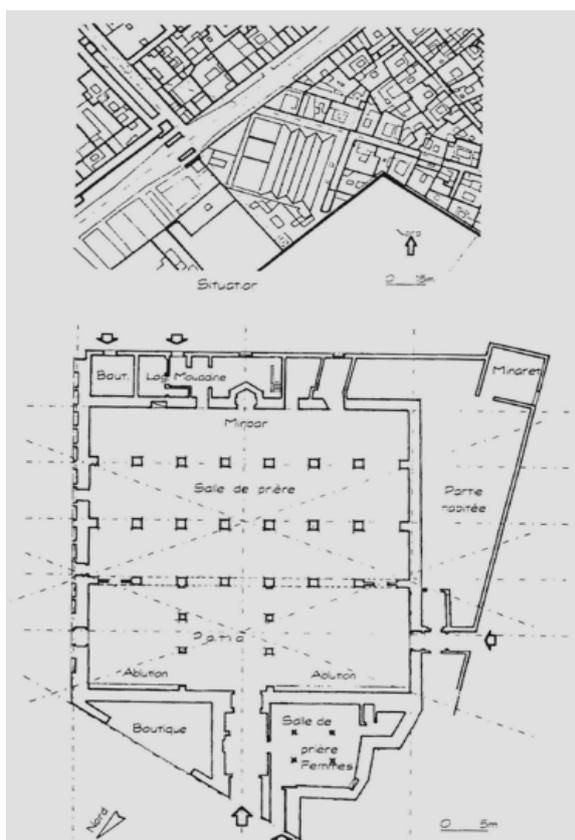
Städtebaulicher Kontext und Grundrisskizze der Moschee Ben Youssef
